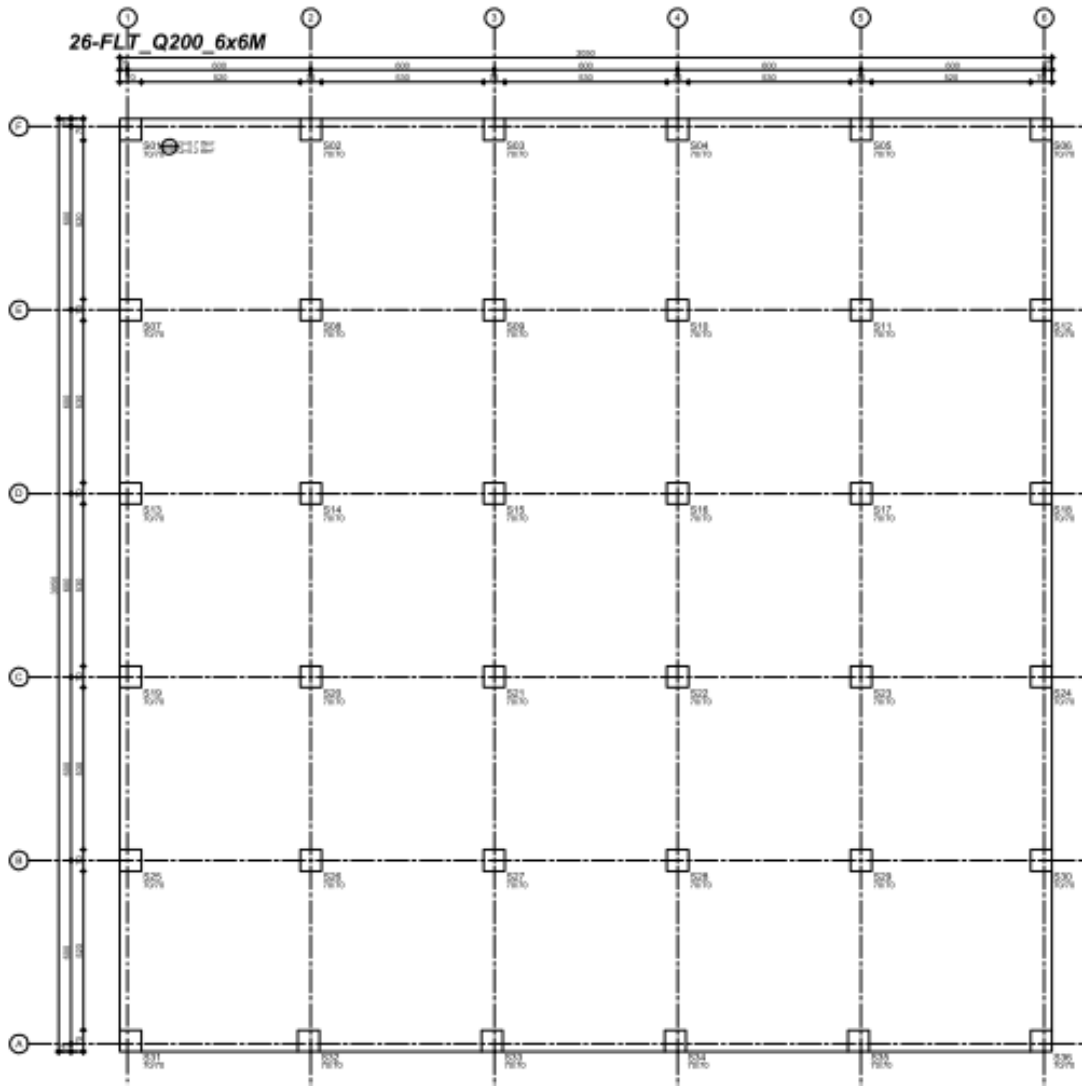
Bir doğrultuda dişli döşeme kalıp planı
